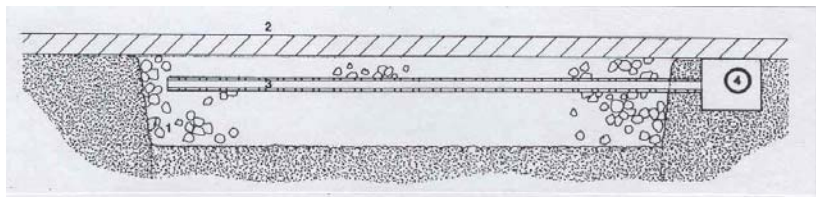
1.- Relleno, 2.- Cubierta, 3.- Tubería perforada o dren, 4.- Cámara salida.
